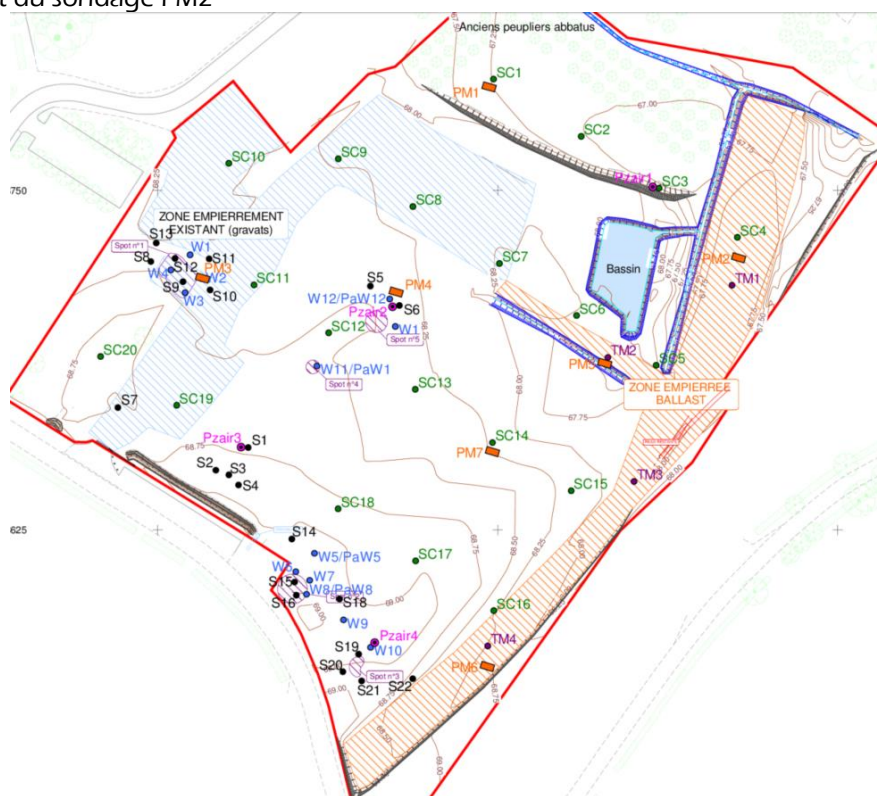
Plan de repérage des matériaux à investiguer (source : CCTP, BURGEAP)
